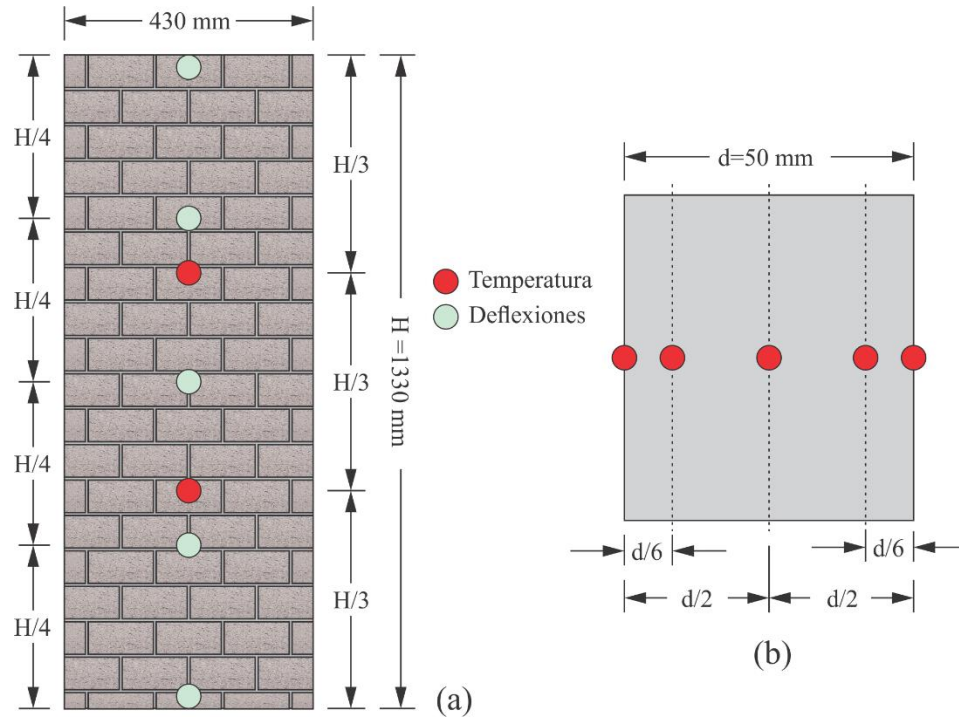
Esquemático de muro de concreto normal. (a) Posiciones de medición superficiales y (b) posición de termopares en la sección transversal del muro [70].
